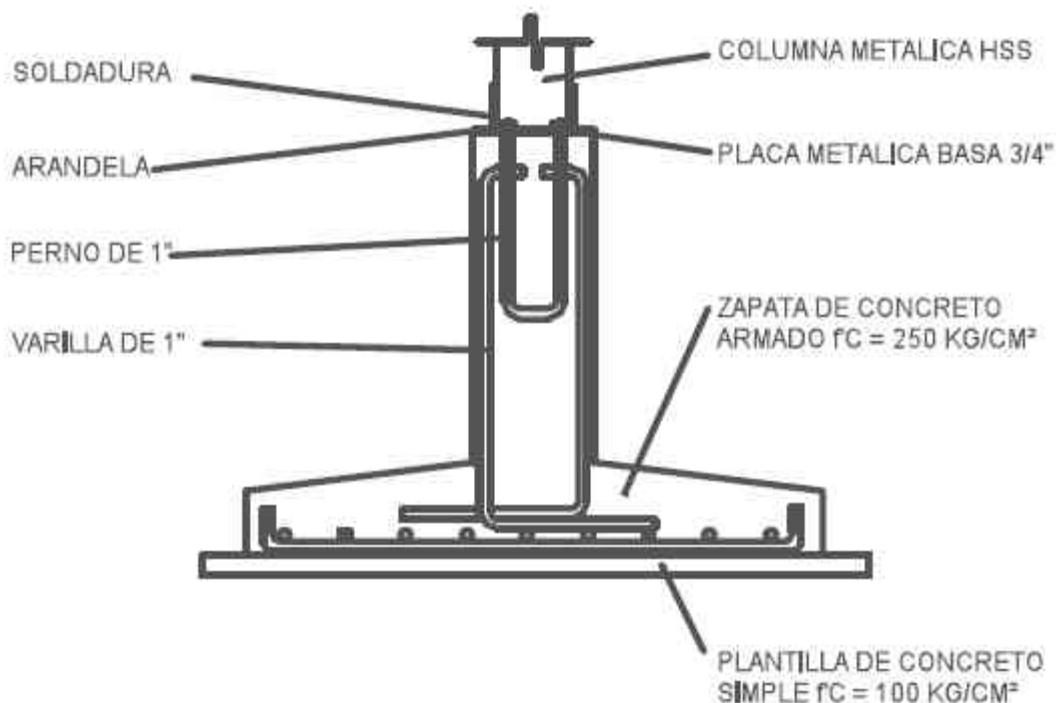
Detalle de zapata con placa para recibir columna metálica. Autor Bernabé Alejo
